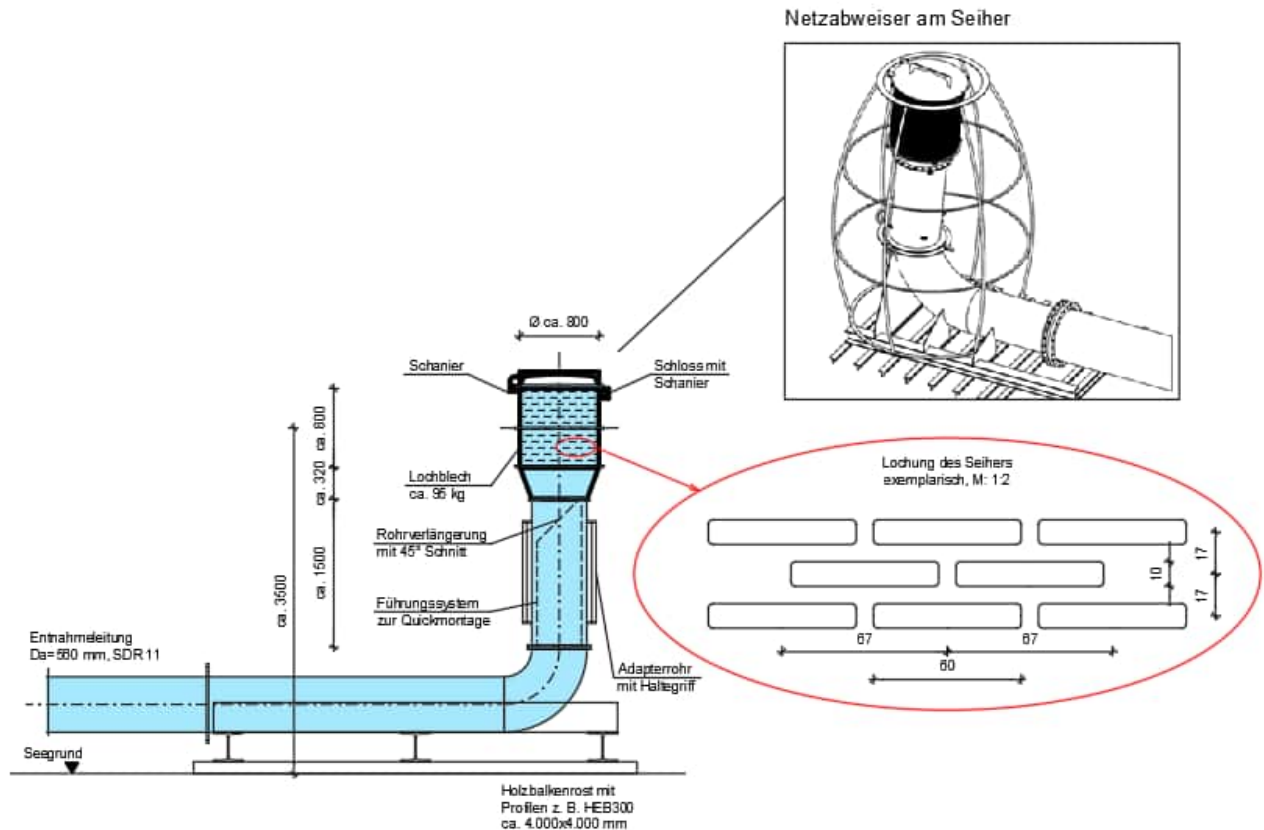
Technische Zeichnung / Konstruktion Einlaufbauwerk
